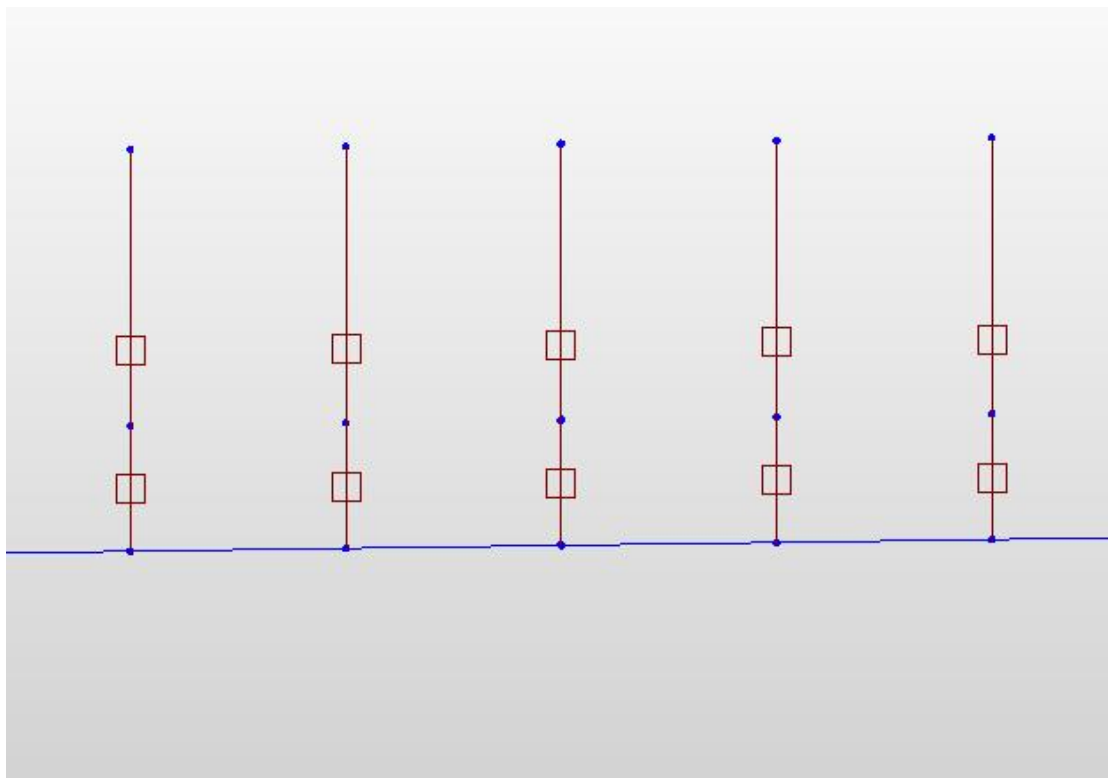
Modellazione della disposizione delle masse lungo l'altezza dell'impalcato
